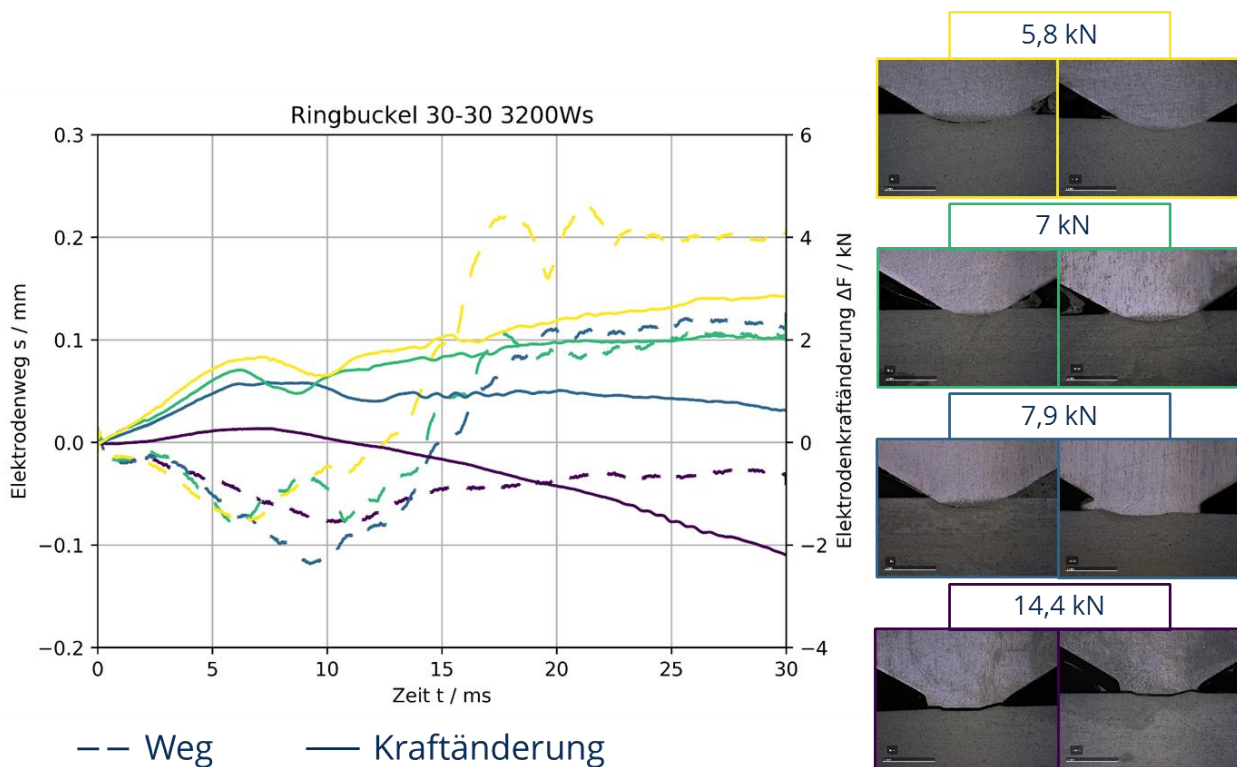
Weg- und Kraftänderung an Maschine 1- Ringbuckel mit Flankenwinkeln 30°/30°
